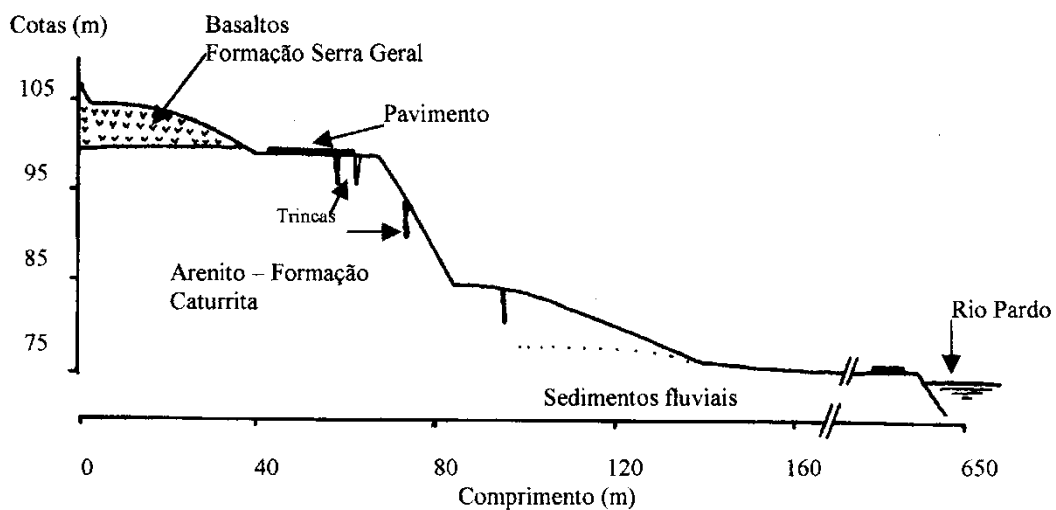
Seção transversal esquemática da área de instabilidade na RS-481, Candelária-Sobradinho.
